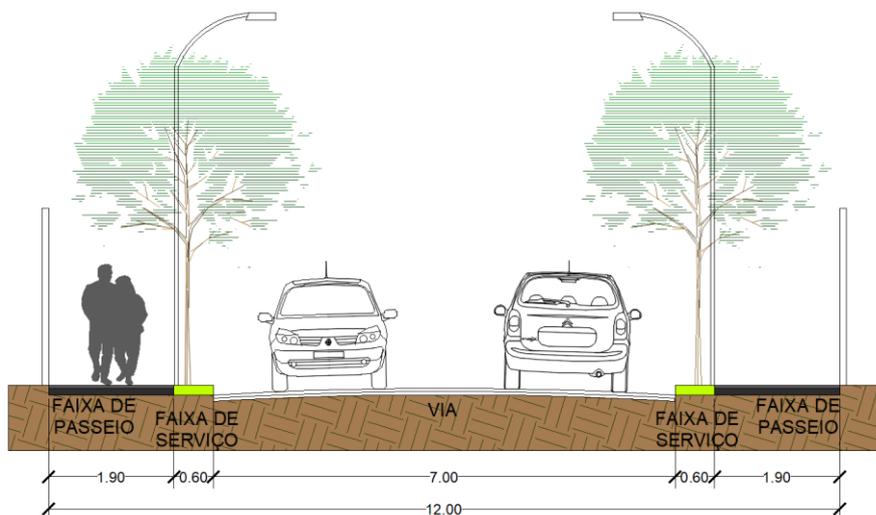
Perfil da Via de Circulação de Vizinhança 2 – Perfil 03 (Fonte: Própria)
